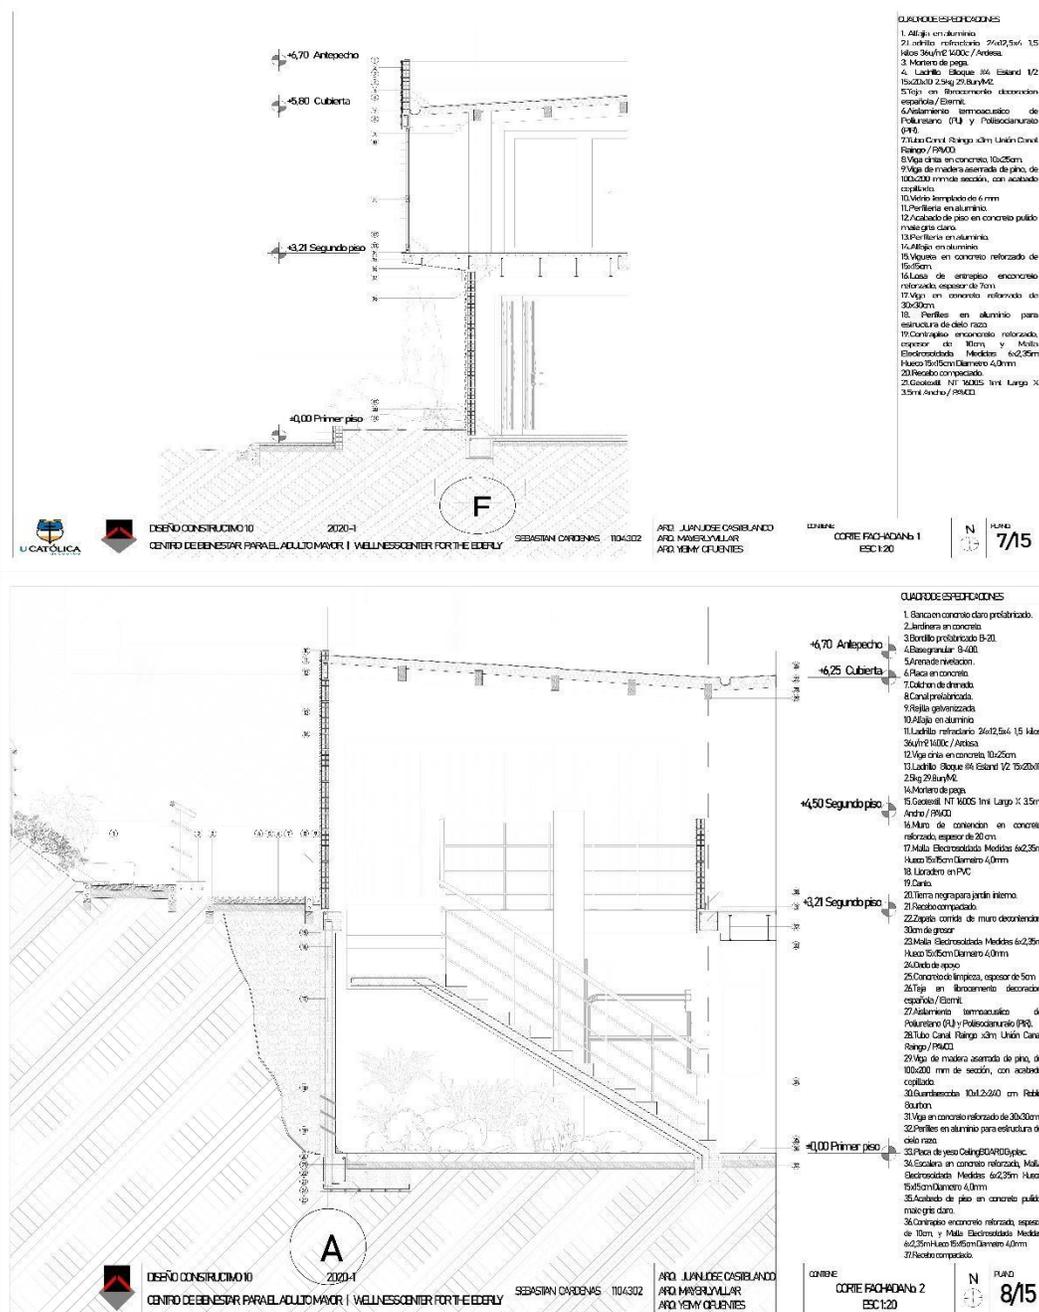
Sección longitudinal y transversal, Detalle de acceso.
